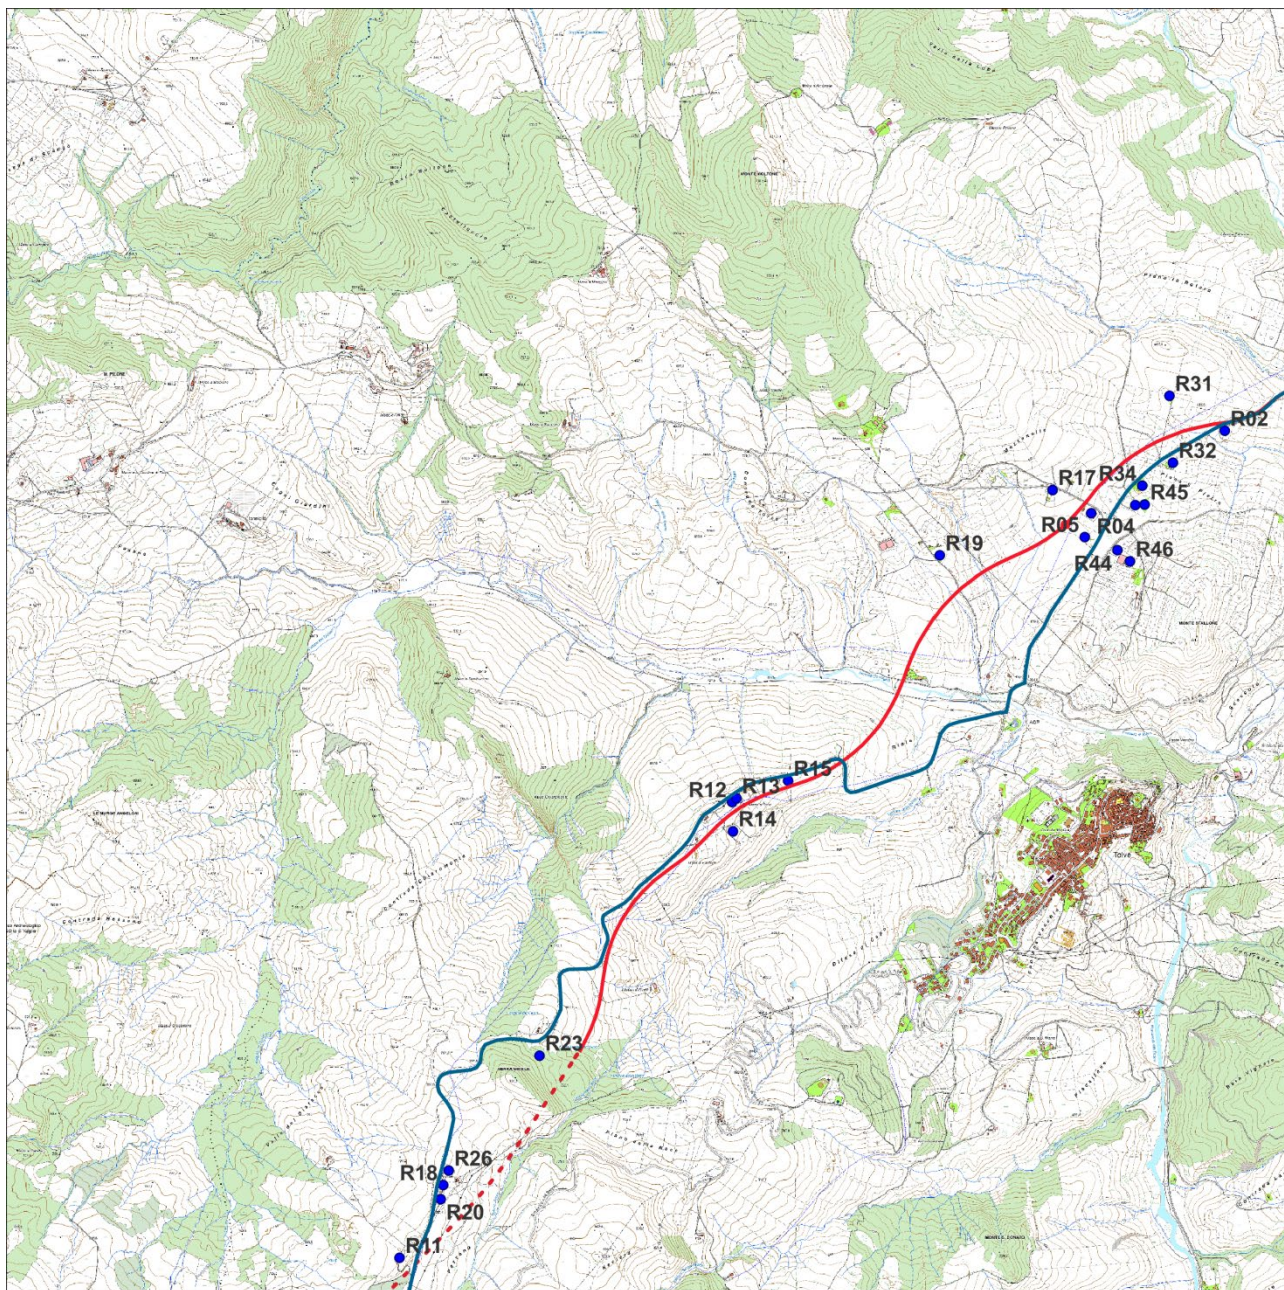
RICETTORI – PLANIMETRIA AREA SVINCOLO TOLVE (BASE CTR 1:10000) – NON IN SCALA
